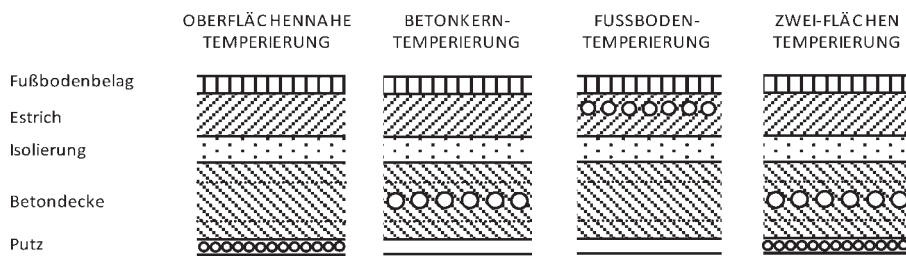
Thermoaktive Bauteilsysteme: Oberflächennahe Temperierung mittels Kapillarrohrmatten, Betonkern-, Fußboden- und Zwei-Flächentemperierung Fig. 2. Thermo-active building systems: surface-near system (capillary tubes), concrete core conditioning, floor conditioning, 2-layer conditioning (from left to right)
